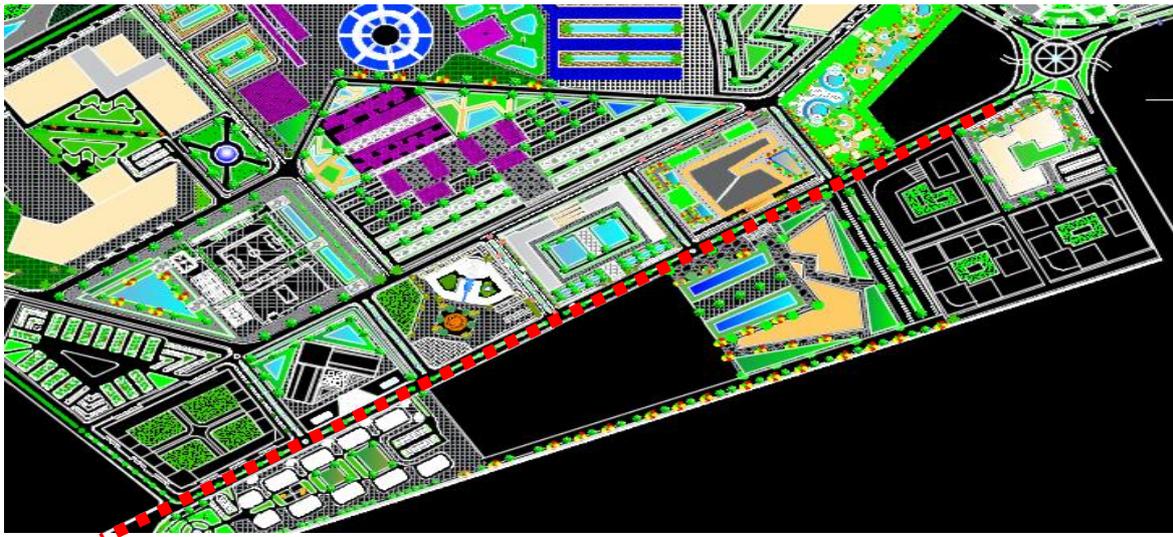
vue en plan de la voie après intervention/source: les auteurs.
